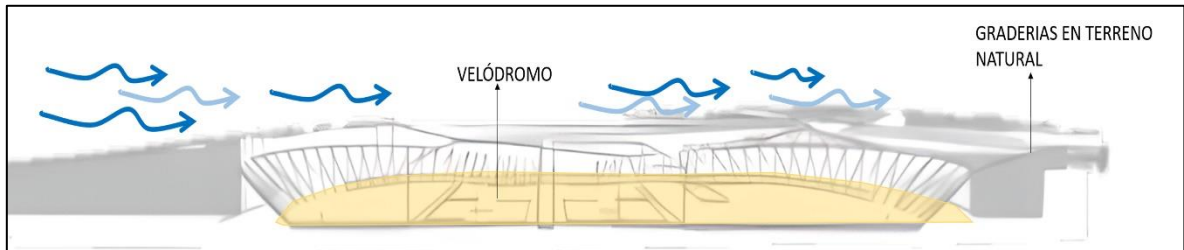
Planta general proyecto arquitectónico, incidencia de sol y dirección de vientos.
